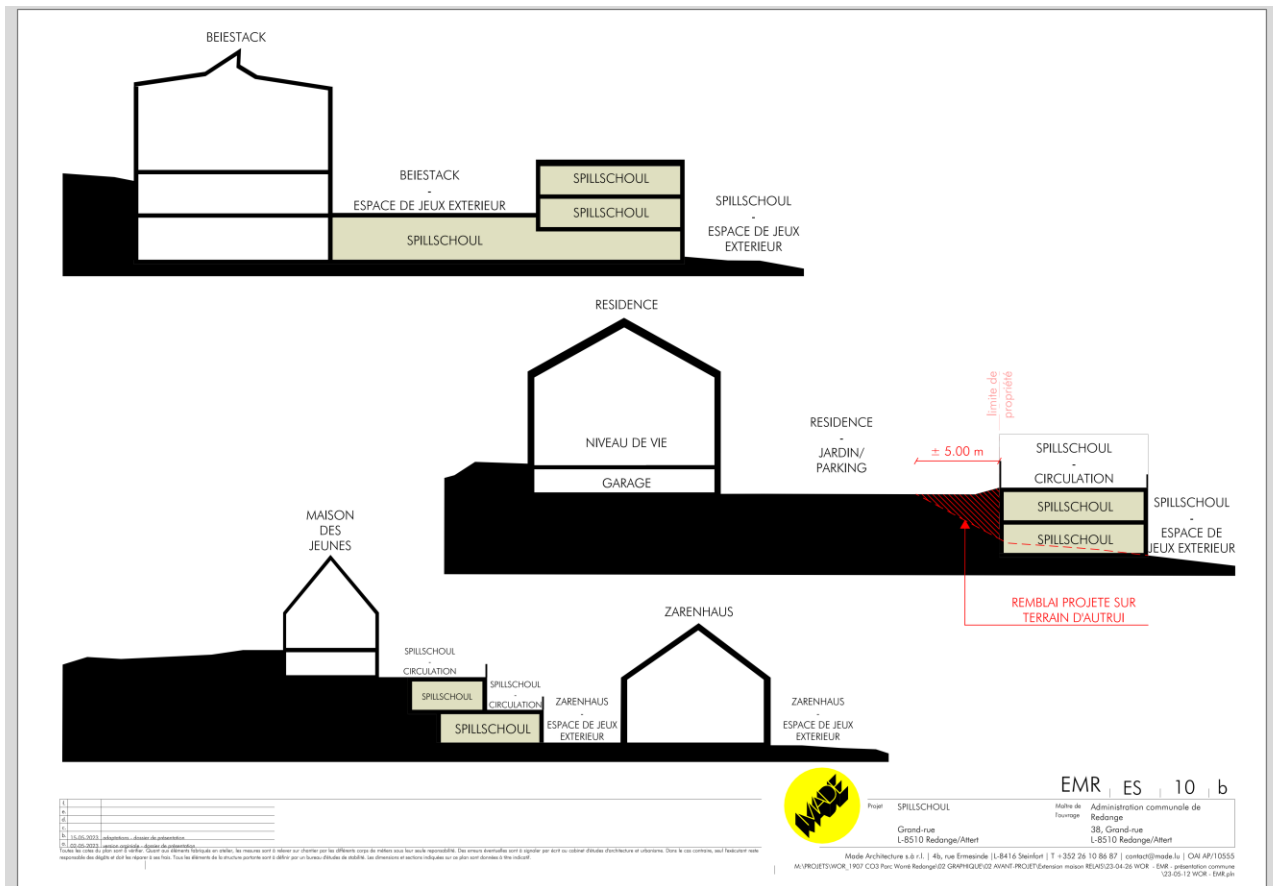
Schnittansichten des geplanten Gebäudekörpers im Vergleich zur Bestandsbebauung. Quelle: Made Architecture 2023
